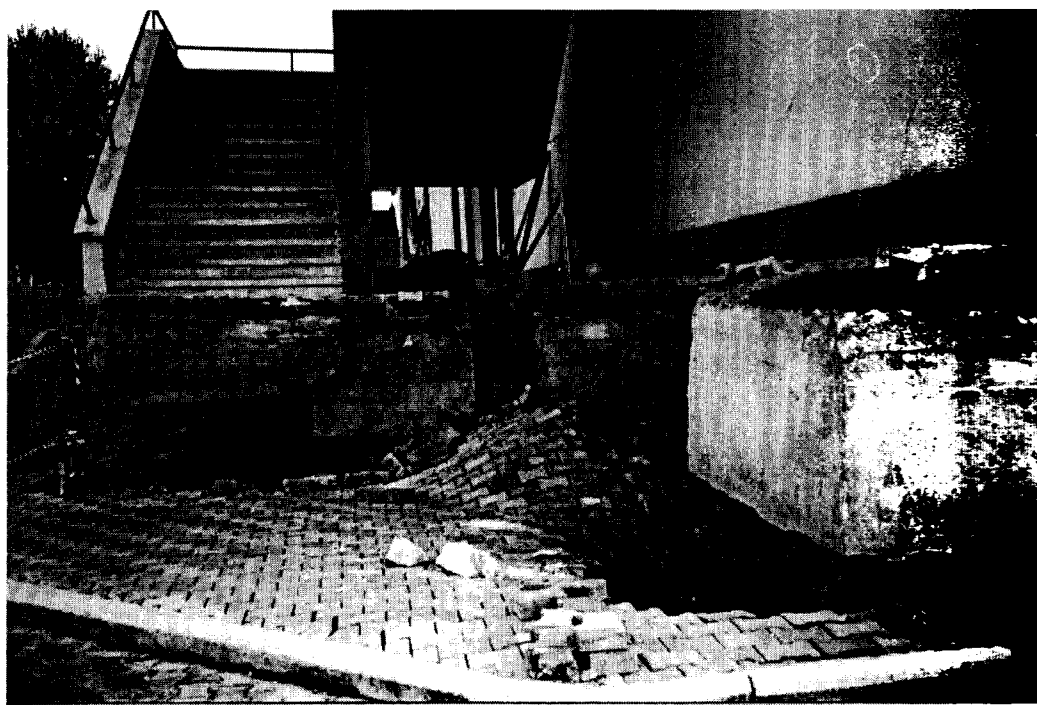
Cimentación del polideportivo elevada por subsidencia del suelo.
